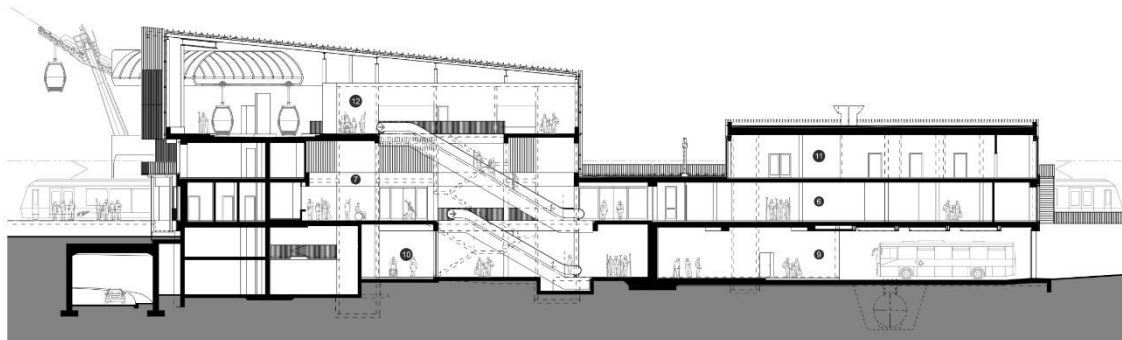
Grundriss ÖV-Hub⁵
